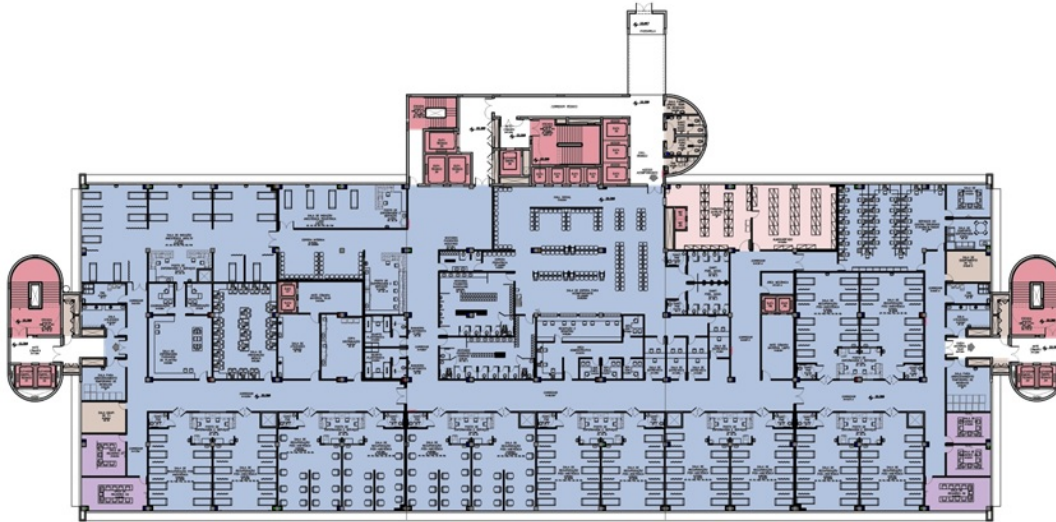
Anexo I - planta baixa do 3º pavimento. (Fonte: material de divulgação projeto de ampliação HCPA)
